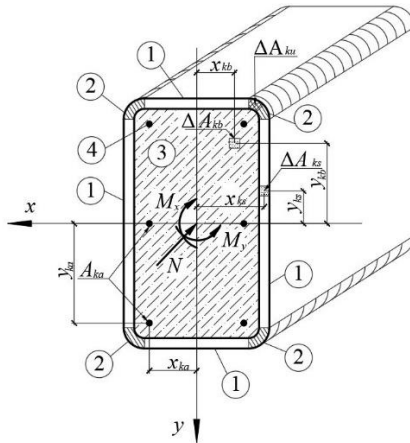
Загрузка трубобетонного элемента прямоугольного сечения:
